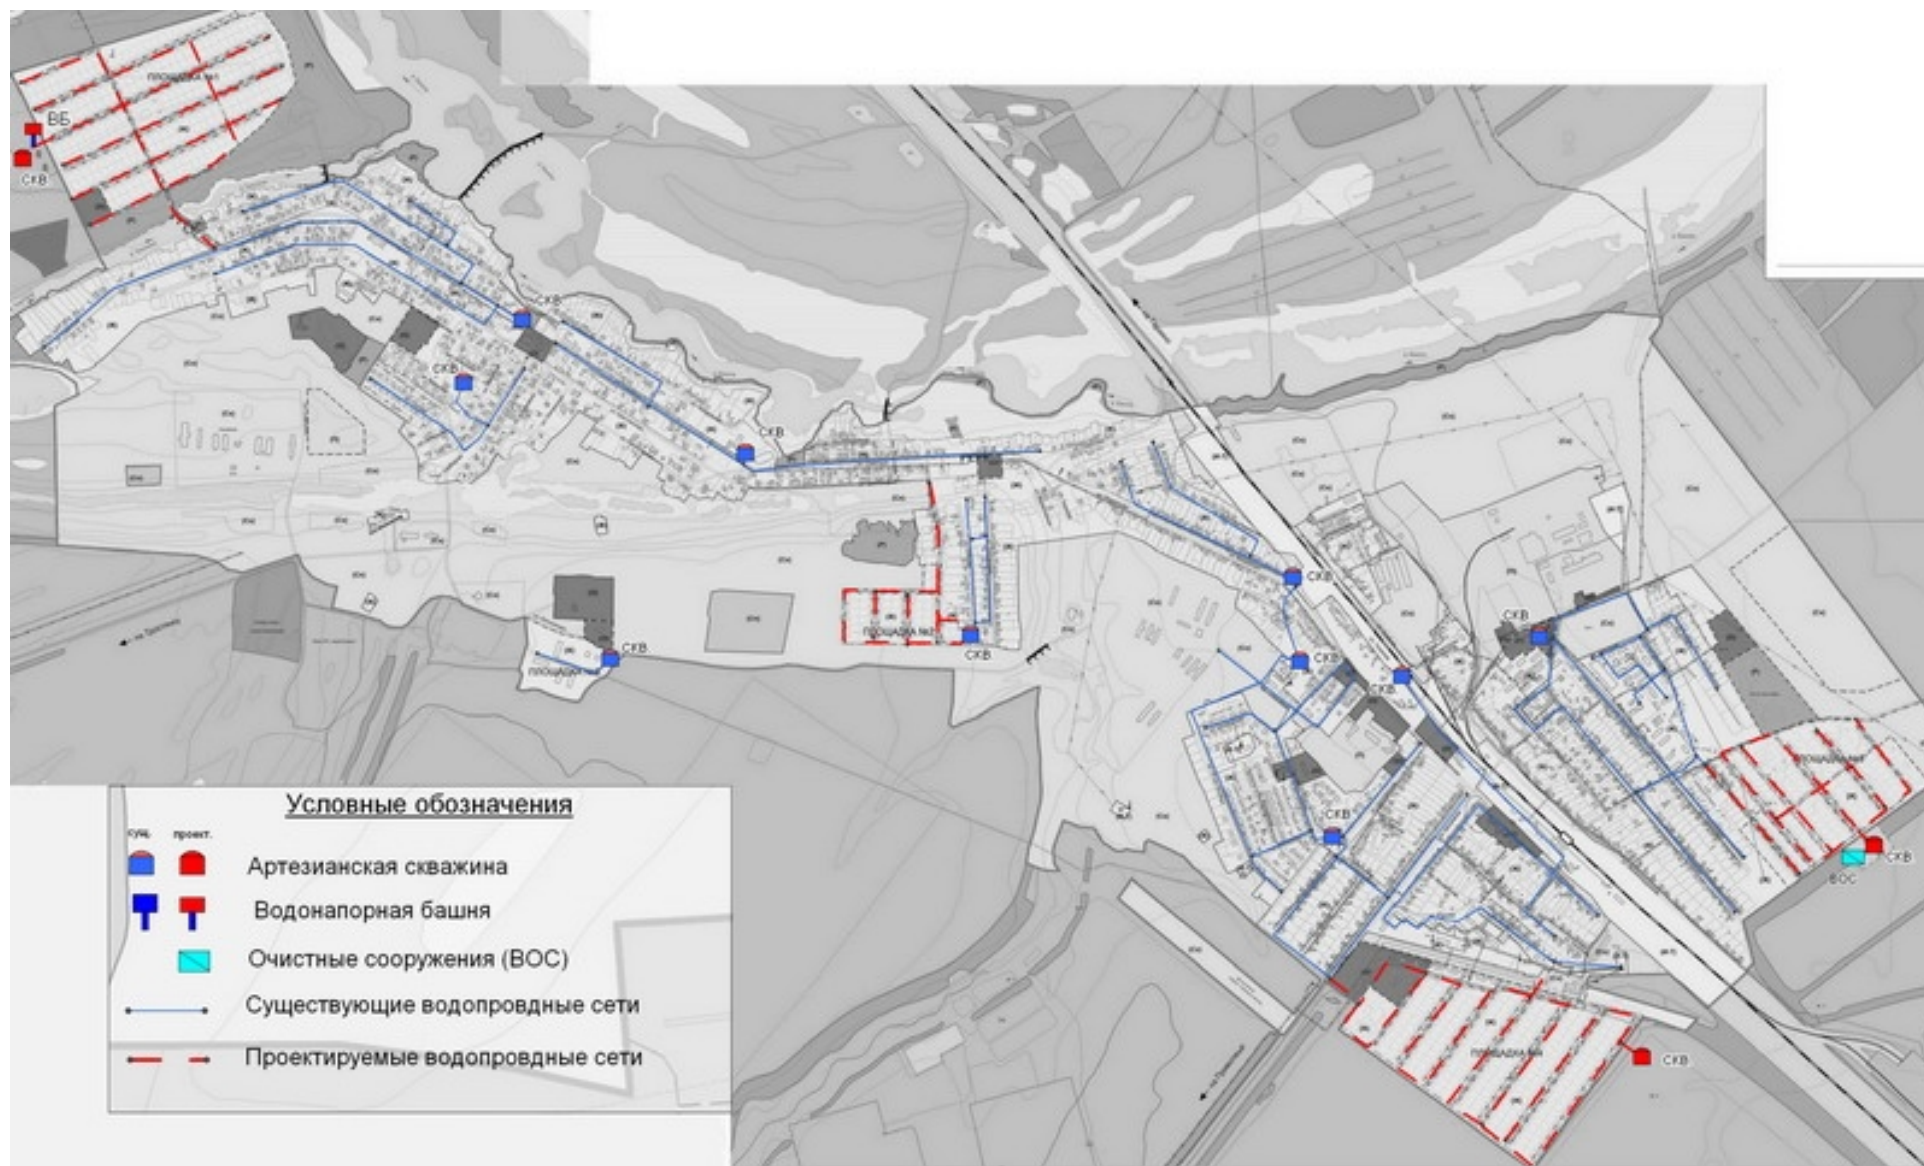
План развития системы водоснабжения с. Обшаровка
